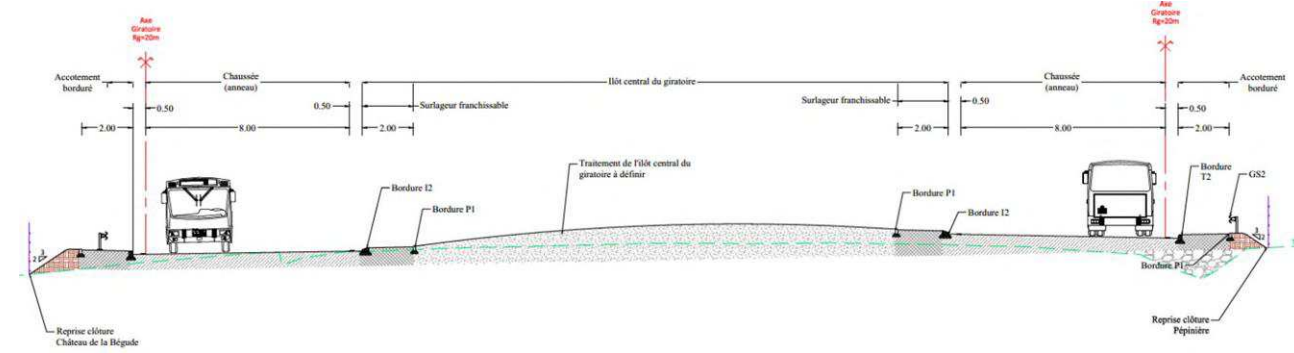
PROFIL EN TRAVERS GIRATOIRE
